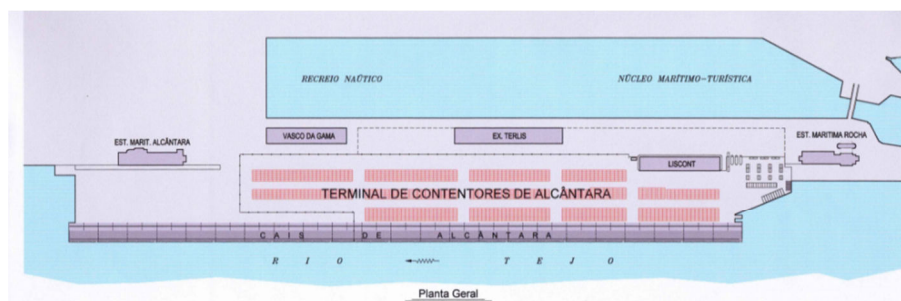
Planta Geral do Terminal de Contentores de Alcântara, Lisboa
